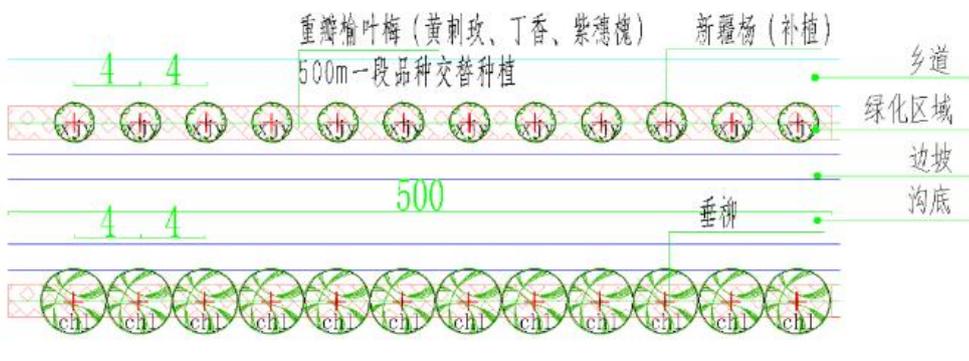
梧桐树干渠边沟缓冲带种植平面图
